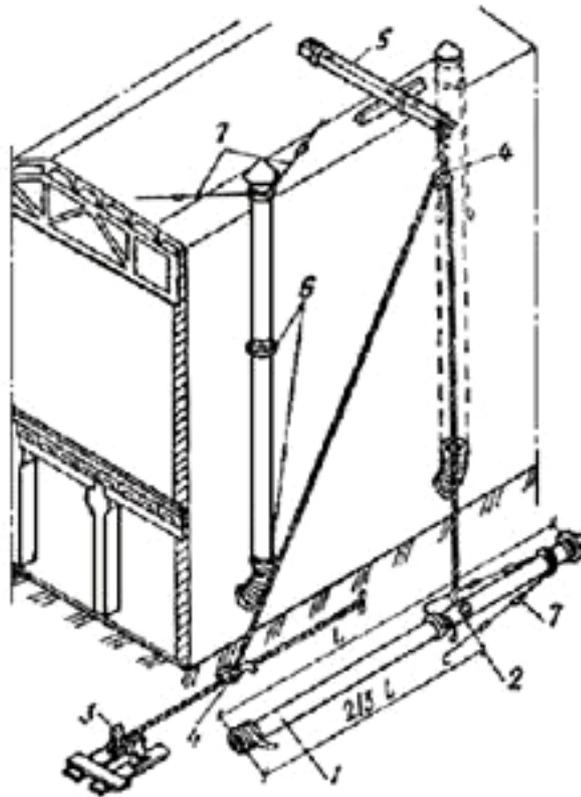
Схема организации рабочей зоны при монтаже вертикальных воздуховодов по наружной стене здания:
